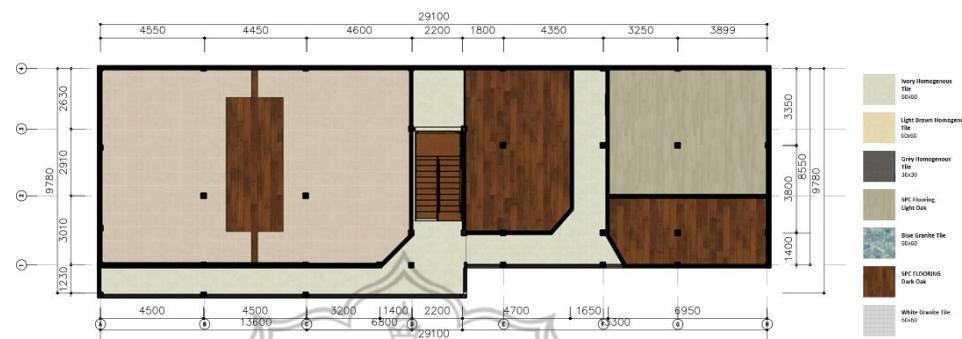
Alternatif 2 Rencana Lantai 1
